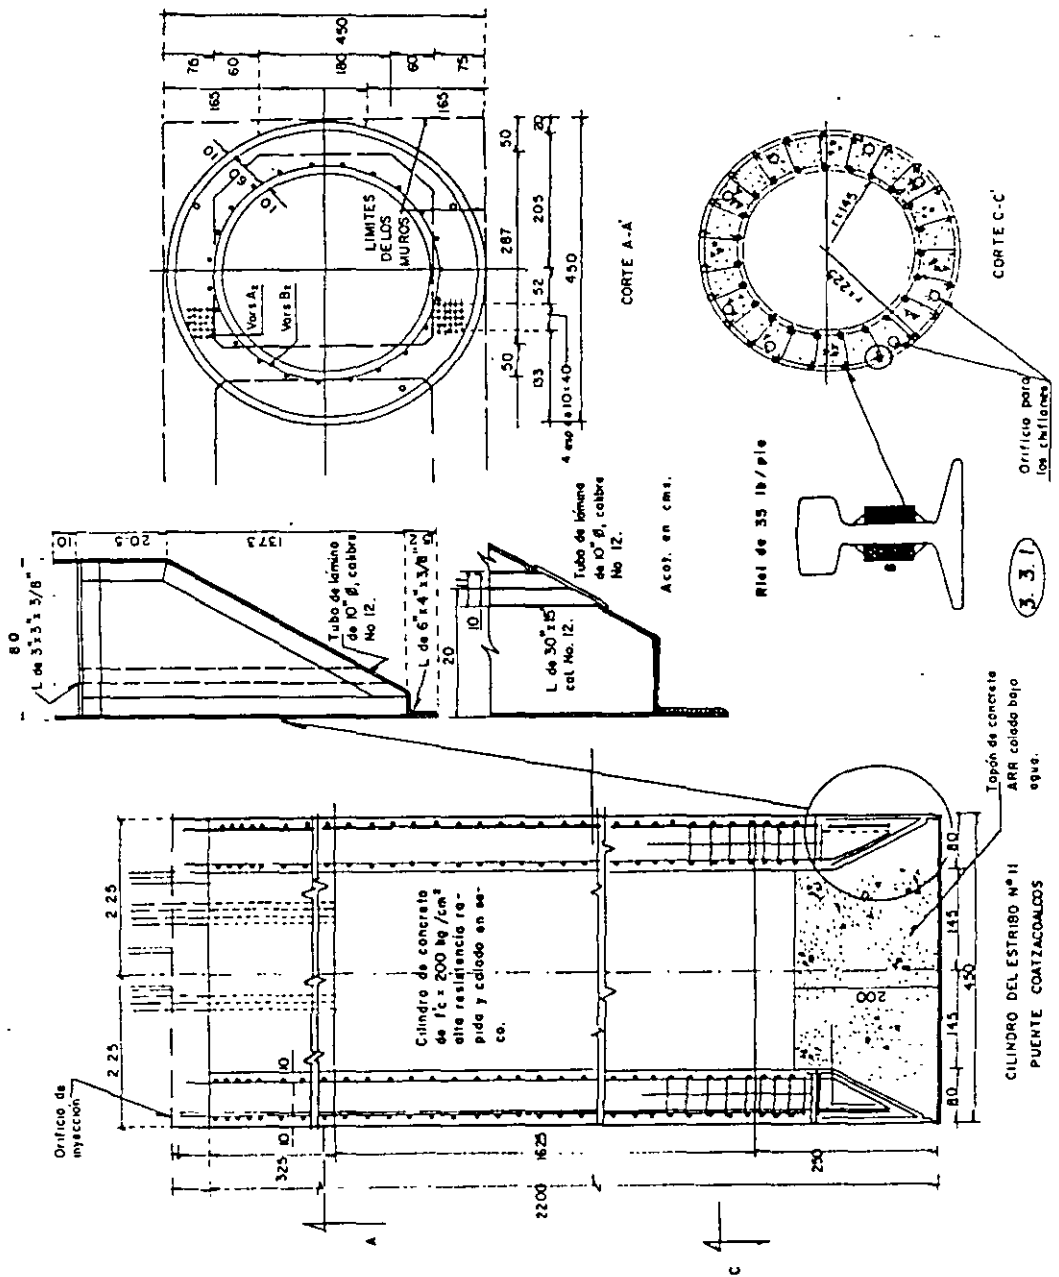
Cilindro de cimentación utilizado en apoyo 11 del puente Coatzacoalcos
